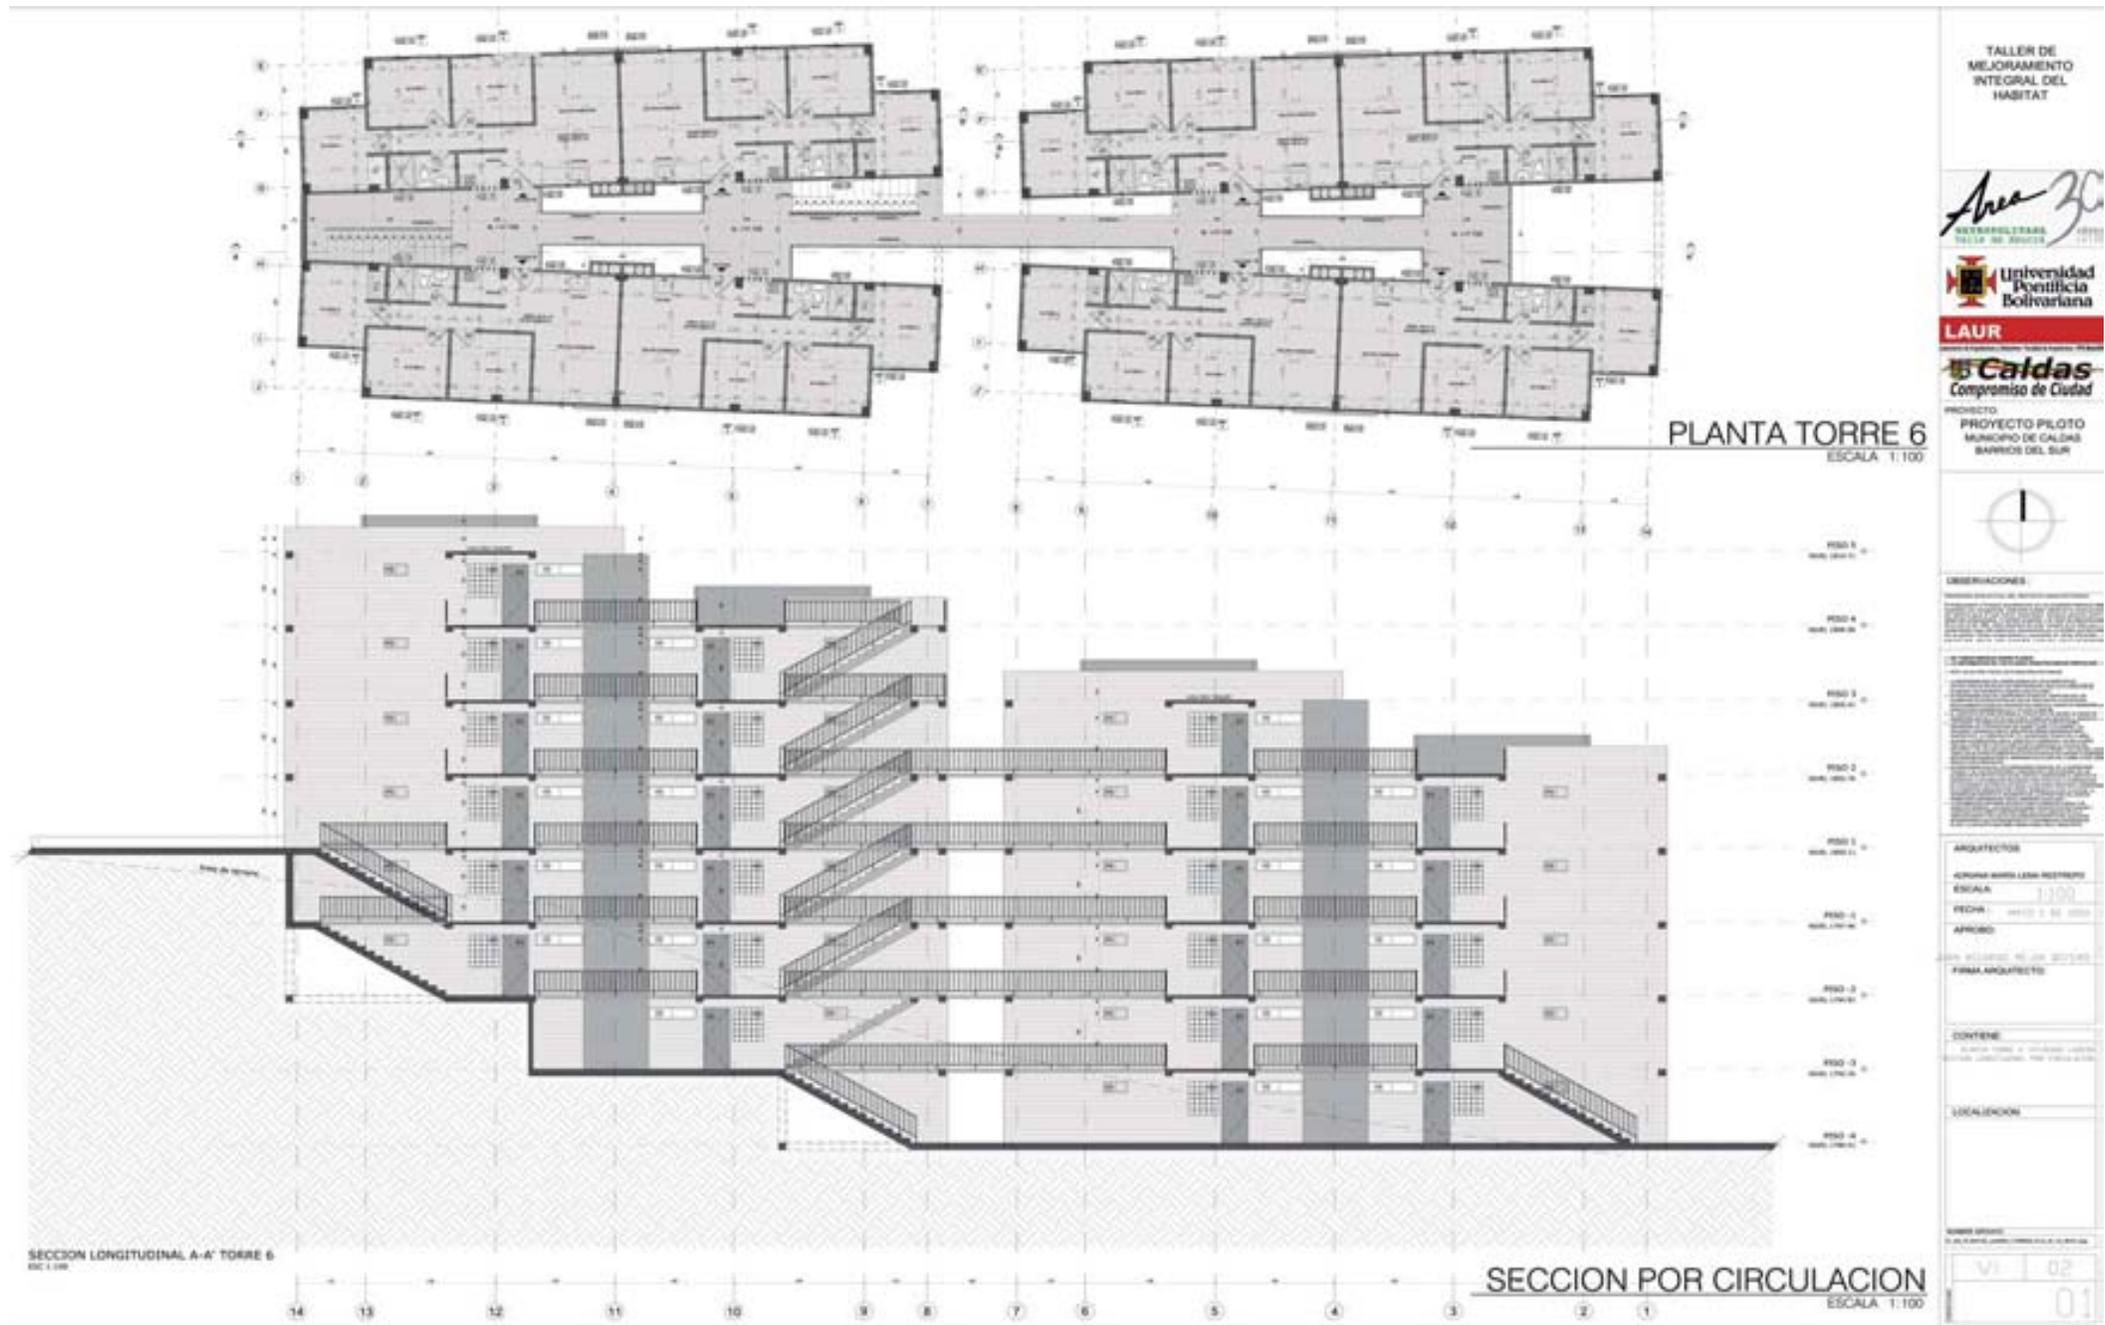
Planta general piso típico y sección por circulación interior de la vivienda en ladera, torre 6
